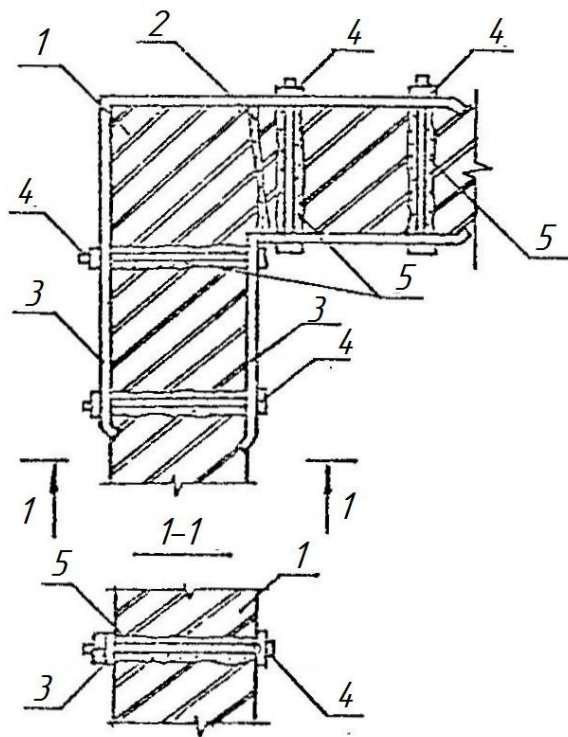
З'єднання кутових зовнішніх стін металевими накладками: 1 – зовнішні кутові стіни; 2 – тріщина; 3 – двобічні металеві накладки; 4 – стяжні болти; 5 – отвори в стіні
